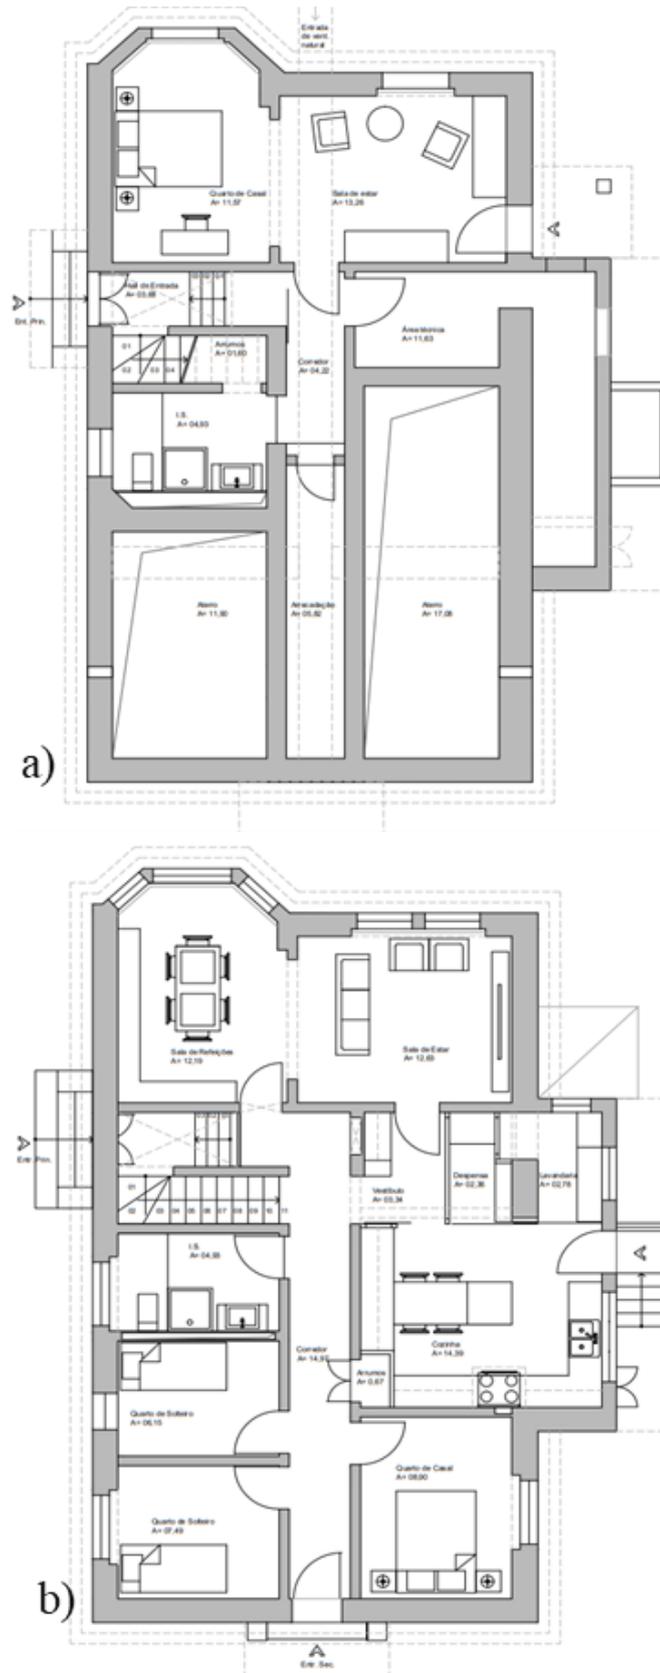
A. 5 - Proposta final: a) planta da cave; b) planta do piso 0 (Fonte: de autor)
